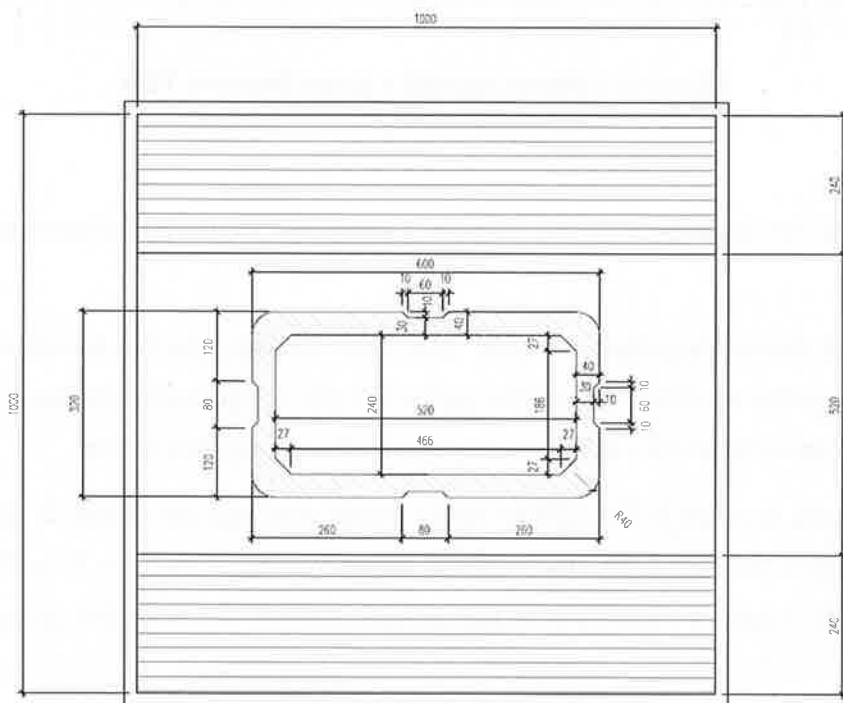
Pianta fondazioni 10x10x2.5m, Bonorva VI01
